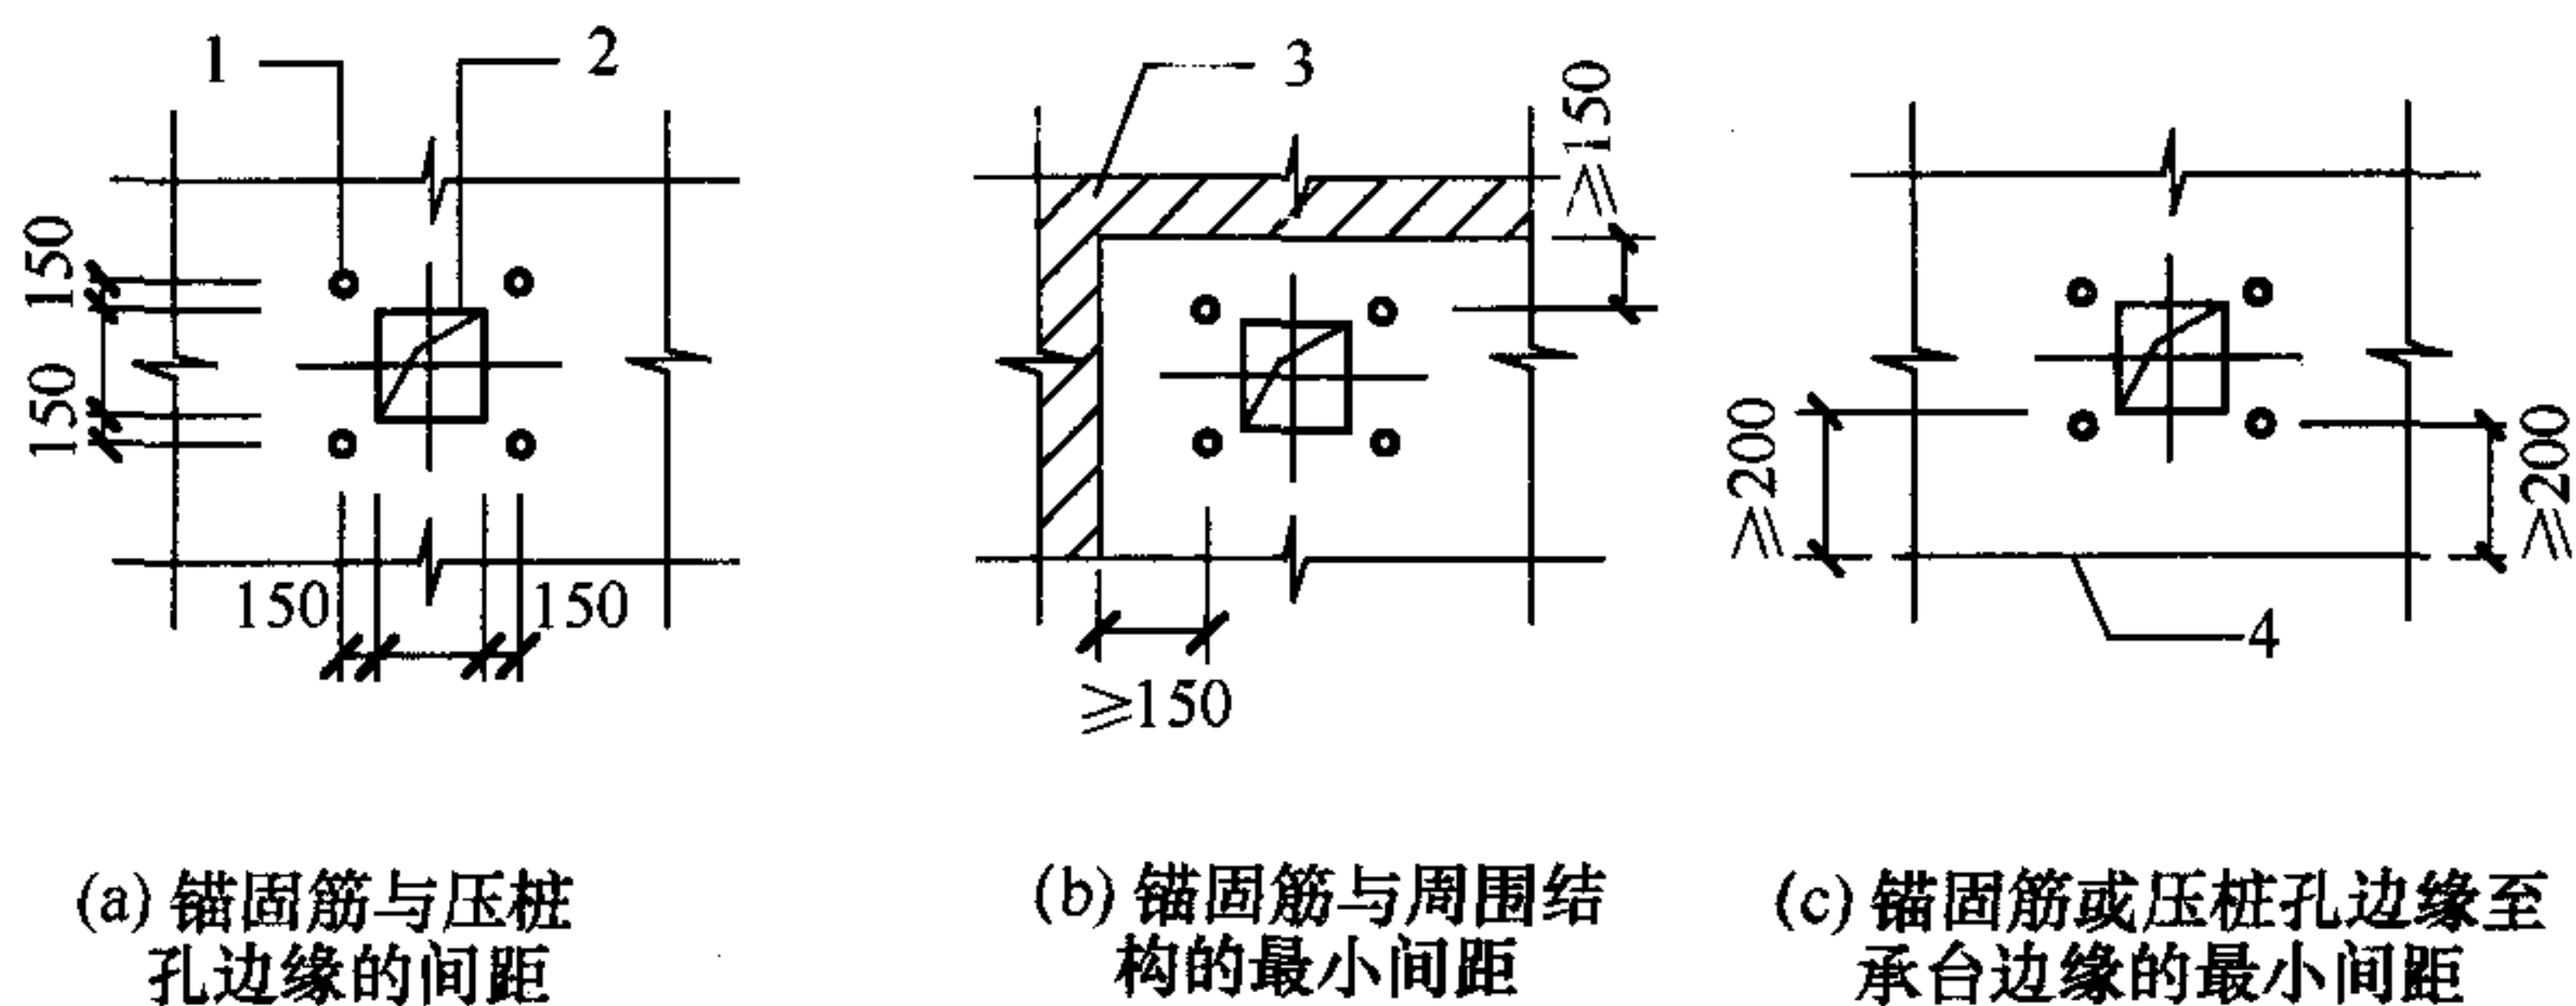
锚固筋与压桩孔布置构造要求
